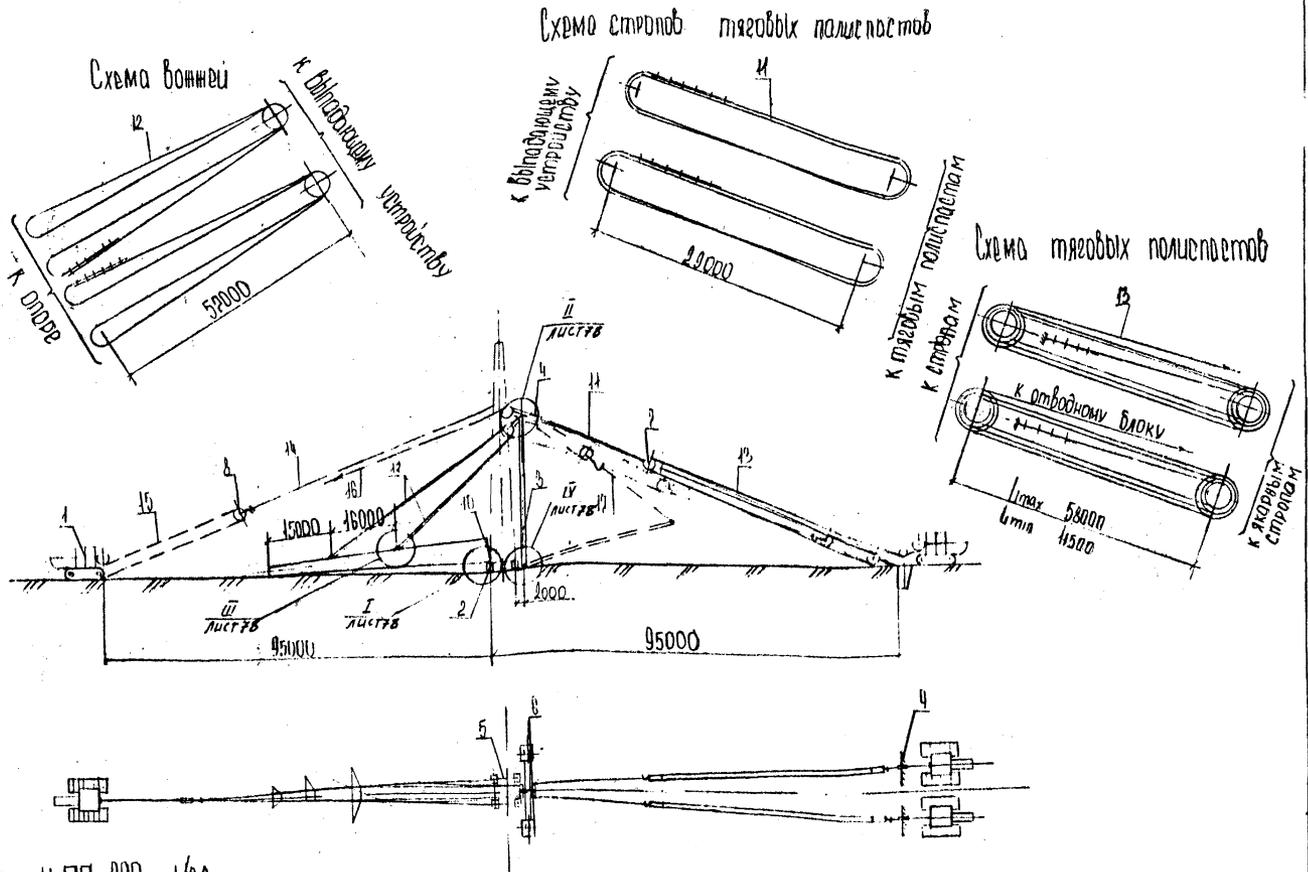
Схема подъема опоры ГП 220 - 1/38
